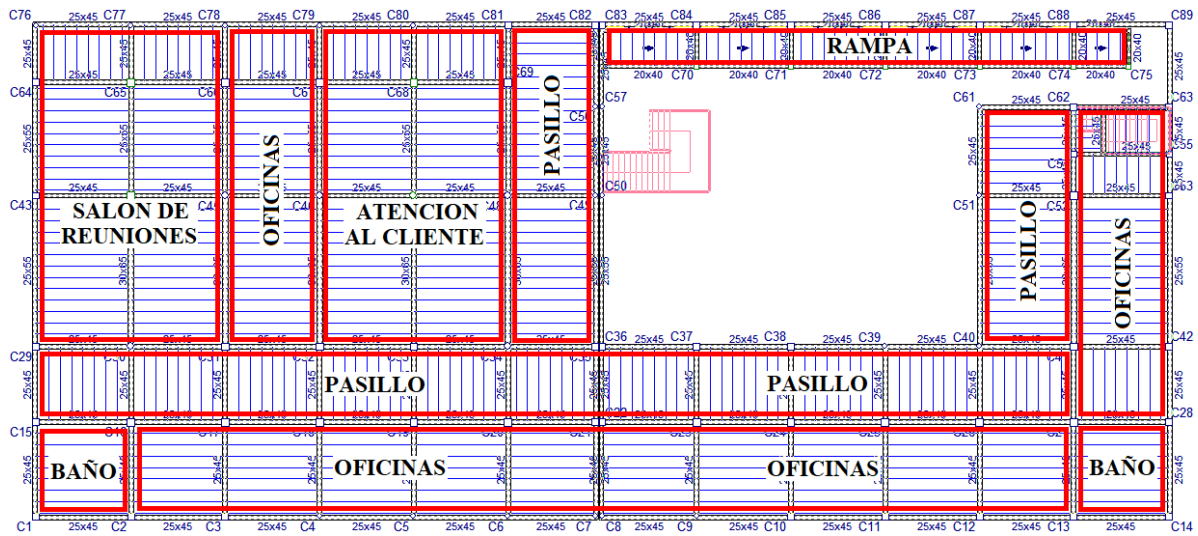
Zonas de uso de la primera losa (fuente: CYPECAD 2017)
